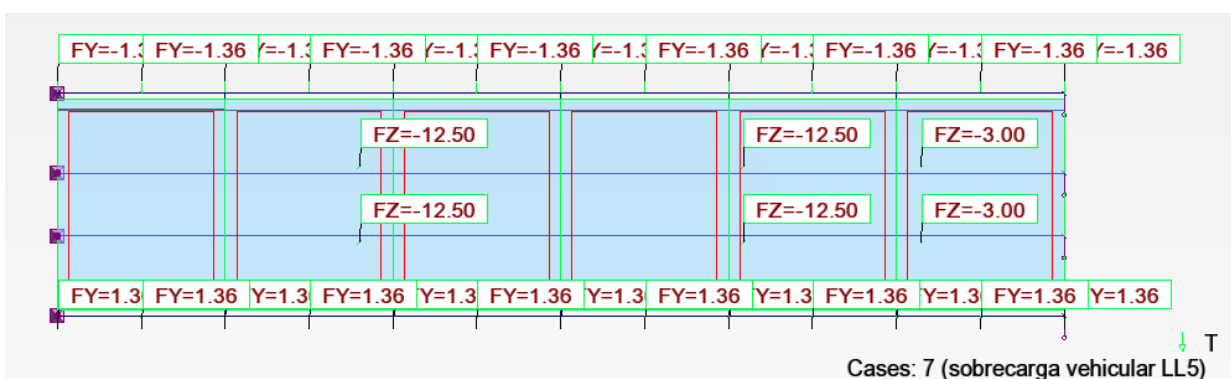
Vista en planta - Carga tipo MOP MODIFICADA
